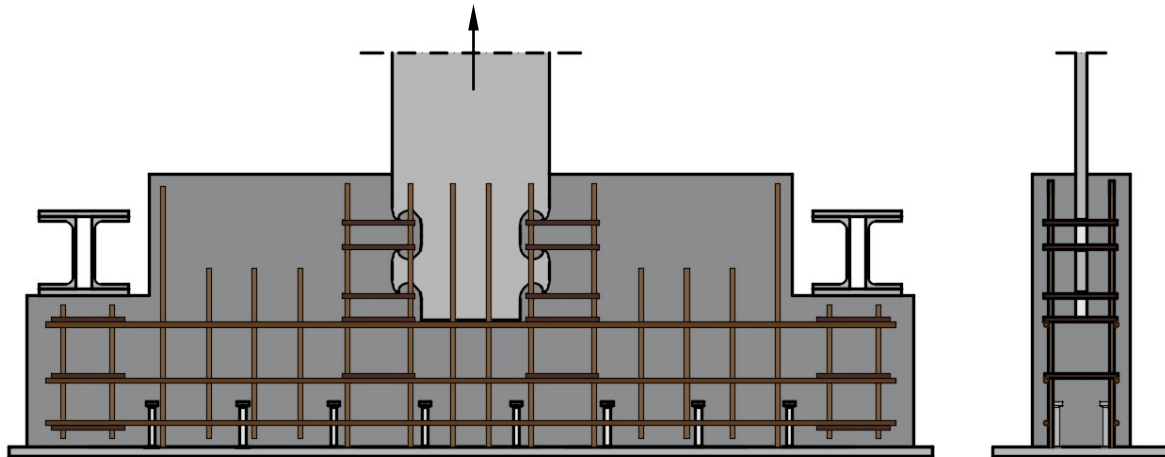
Vorderansicht (links) und Seitenansicht (recht) des Probekörpers aus Stahlbeton mit der Lage des eingelassenen Betondübel (hellgrau) und der Lage der horizontalen und vertikalen Bewehrungsstäbe. Der Pfeil gibt die Richtung der Zugkraft an.
